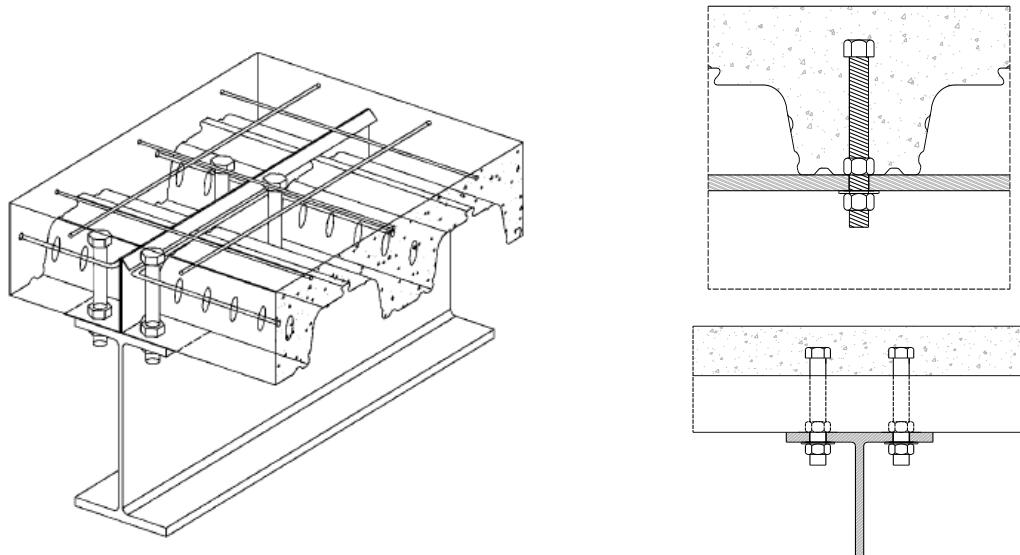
Système de plancher mixte démontable permettant le réemploi des segments de dalles [35]
